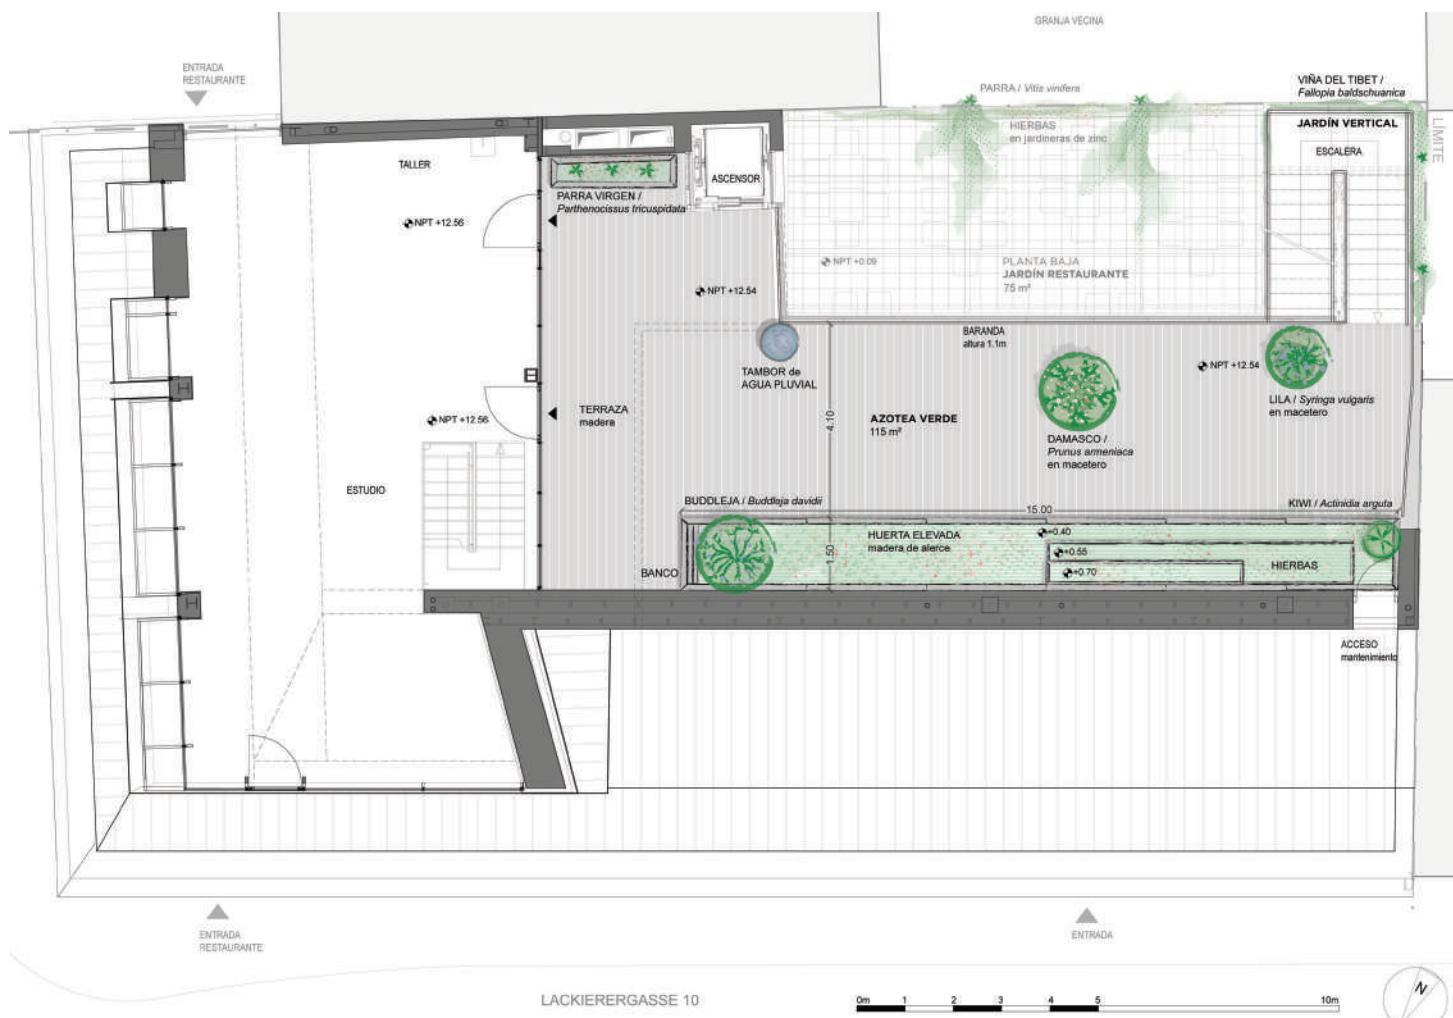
Plano de la azotea verde (fuente: Elaboración propia en base a un plano de gaupenraub+/-).
